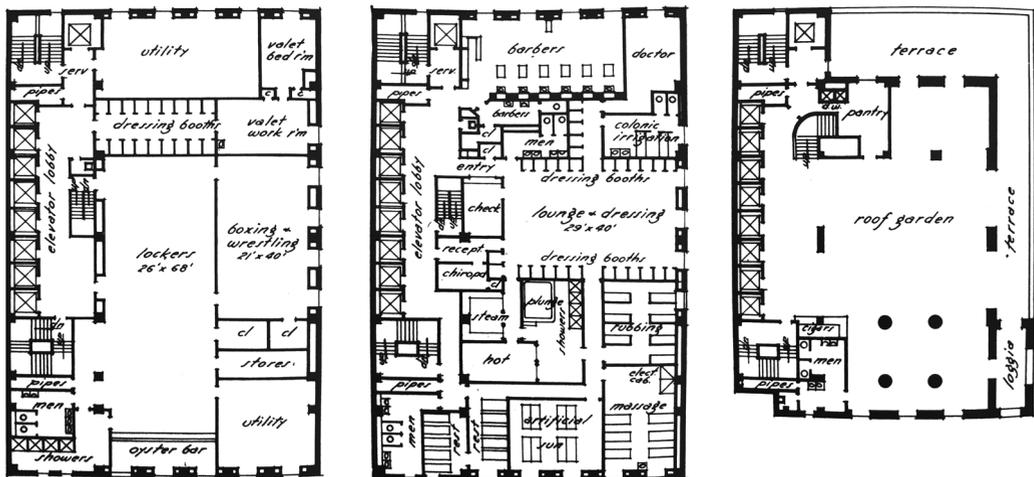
Grundrisse des Downtown Athletic Clubs.
